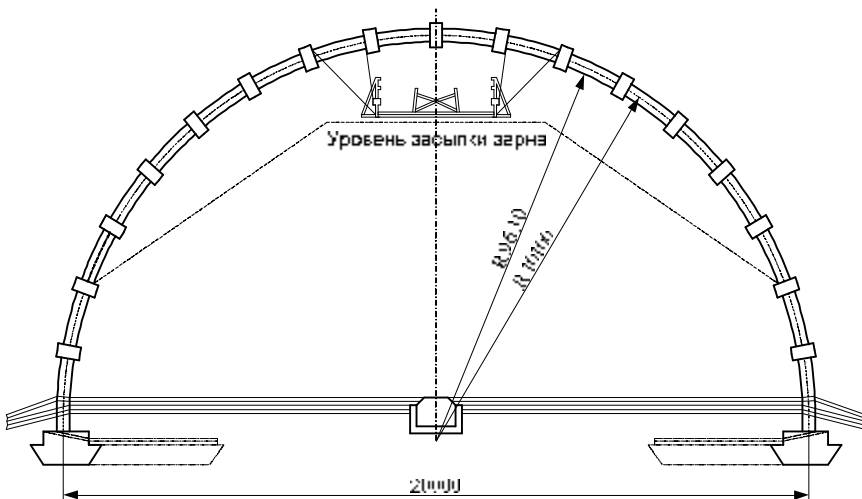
Механизированный зерновой склад облегченной сводчатой конструкции
